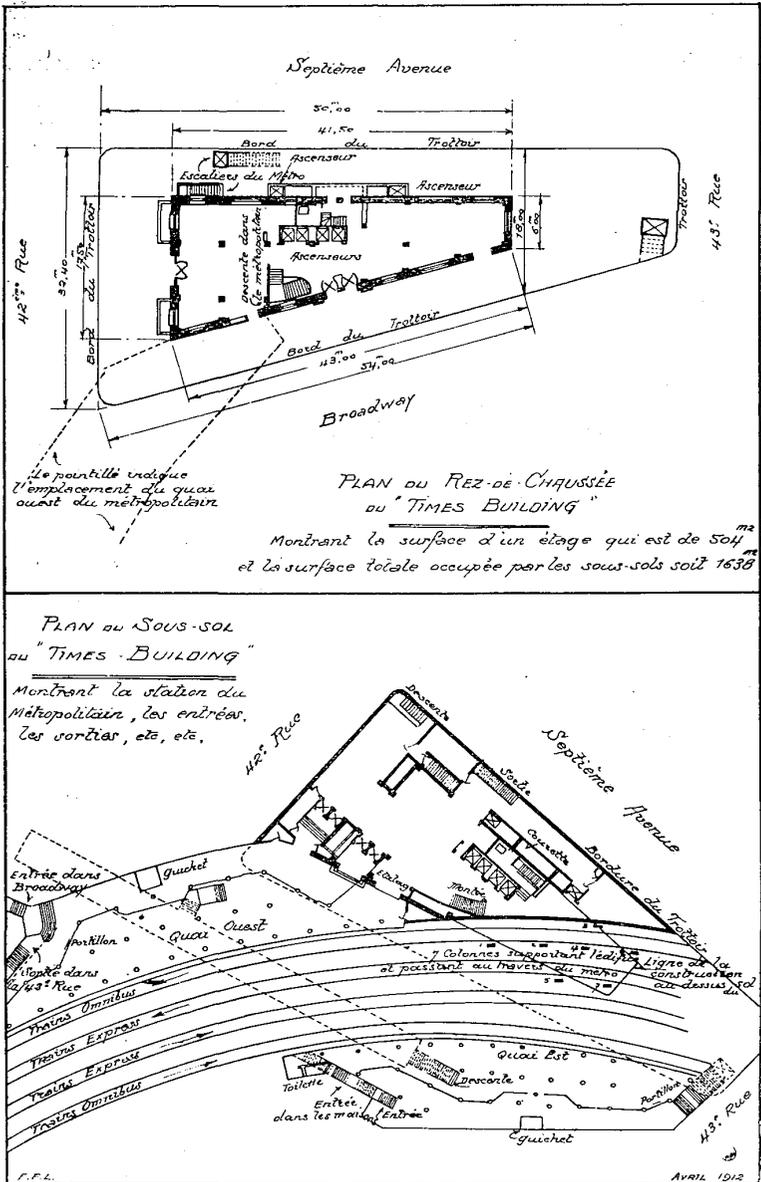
Rez-de-chaussée et premier sous-sol du Times Building.
